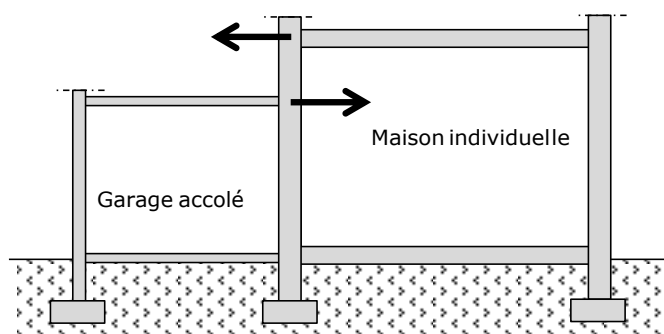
exemple de sollicitations supplémentaires sur la maison individuelle accolée à un garage
